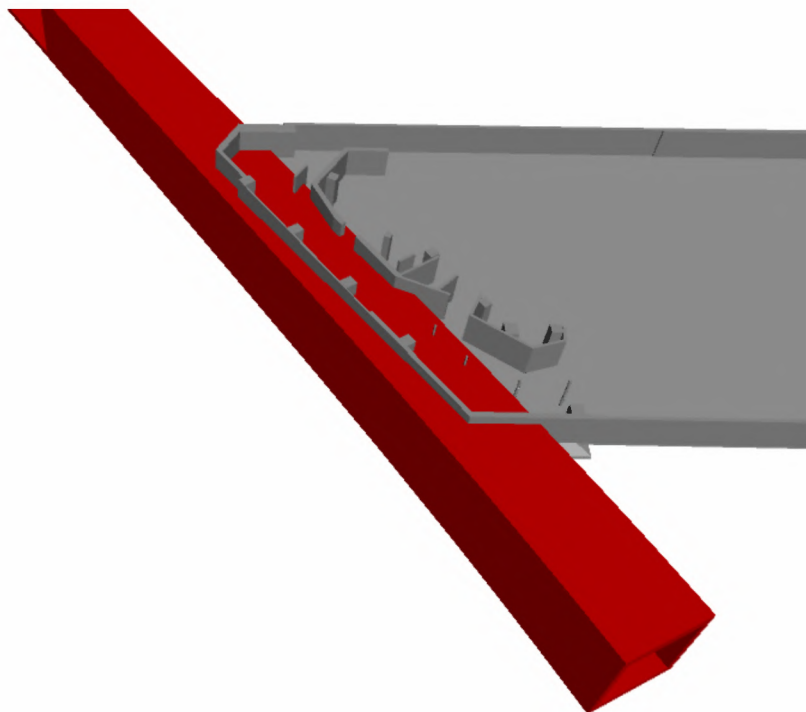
Kollision der neuen City-Tunnel-Röhre mit dem Bieberhaus
